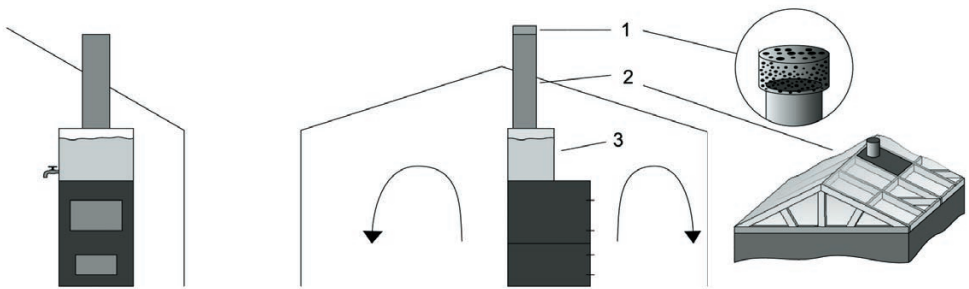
Отопление металлической печью: 1 — искрогаситель; 2 — термоизоляционная «юбка» вокруг трубы; 3 — бак с водой
